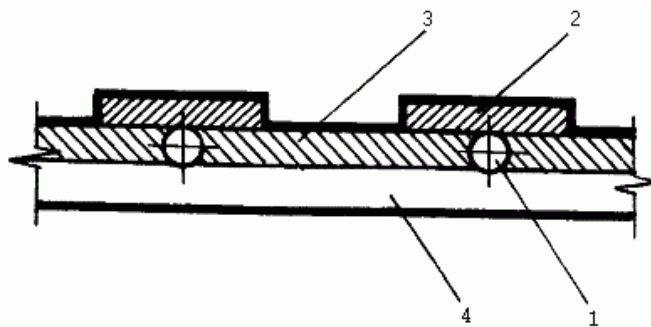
Вариант крепления реек: 1 – дуги из труб; 2 – отрезок рейки; 3 – длинная рейка; 4 – пленка
